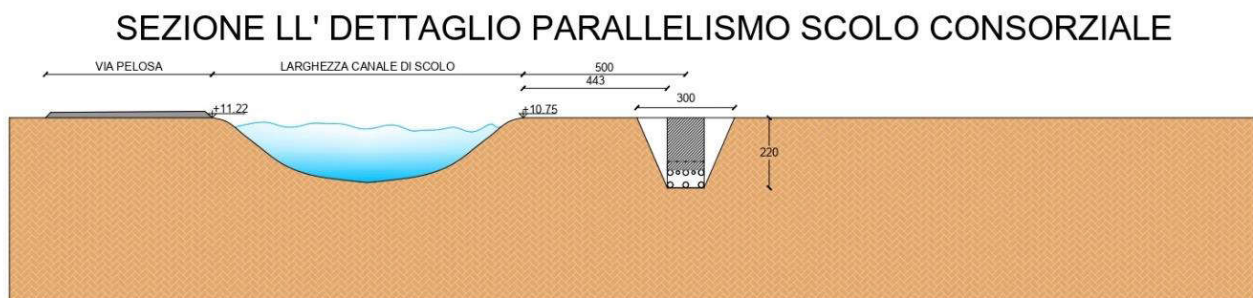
Sezione L-L' – Parallelismo canale di scolo e cavidotto
